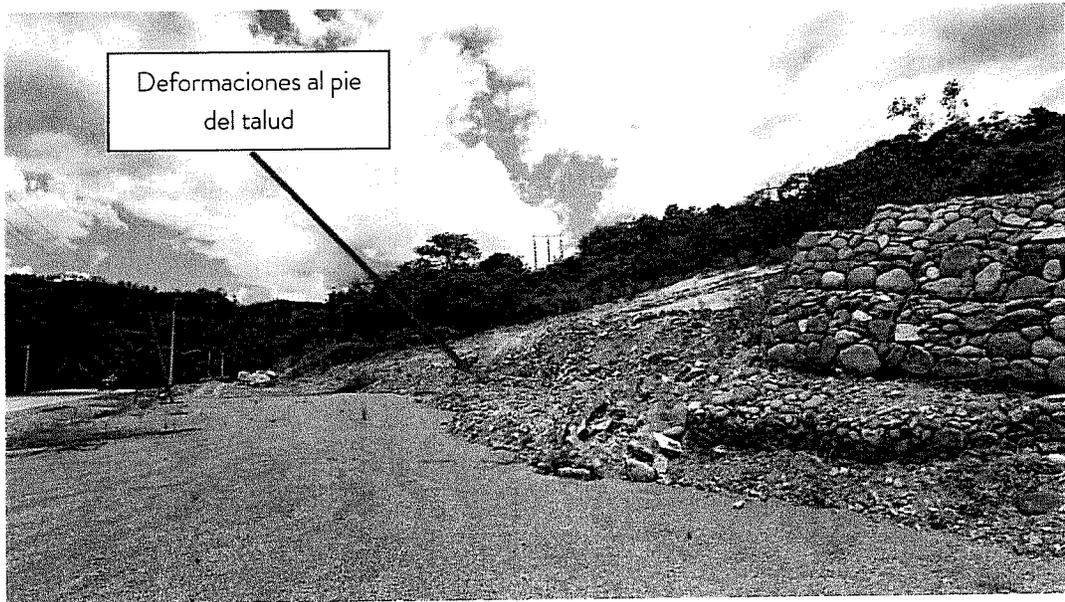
Muro de gaviones con levantamiento en la base.
